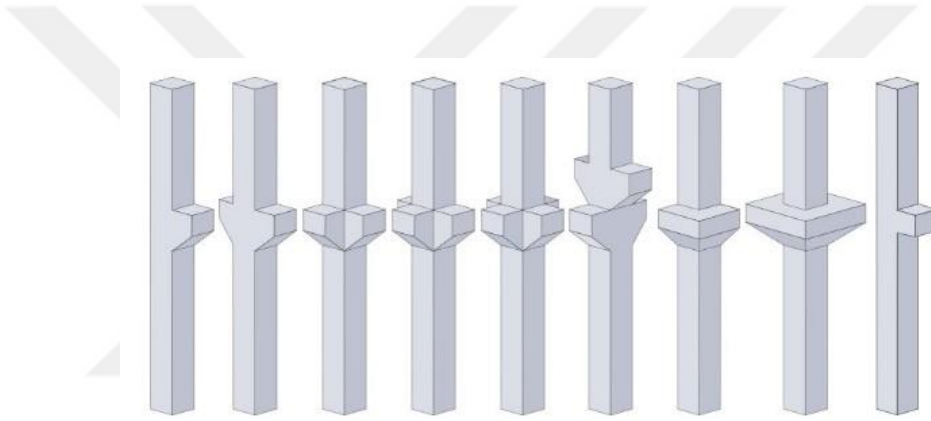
Prefabrike beton iskelet sistem oluşumu (Anonim, 2009)
